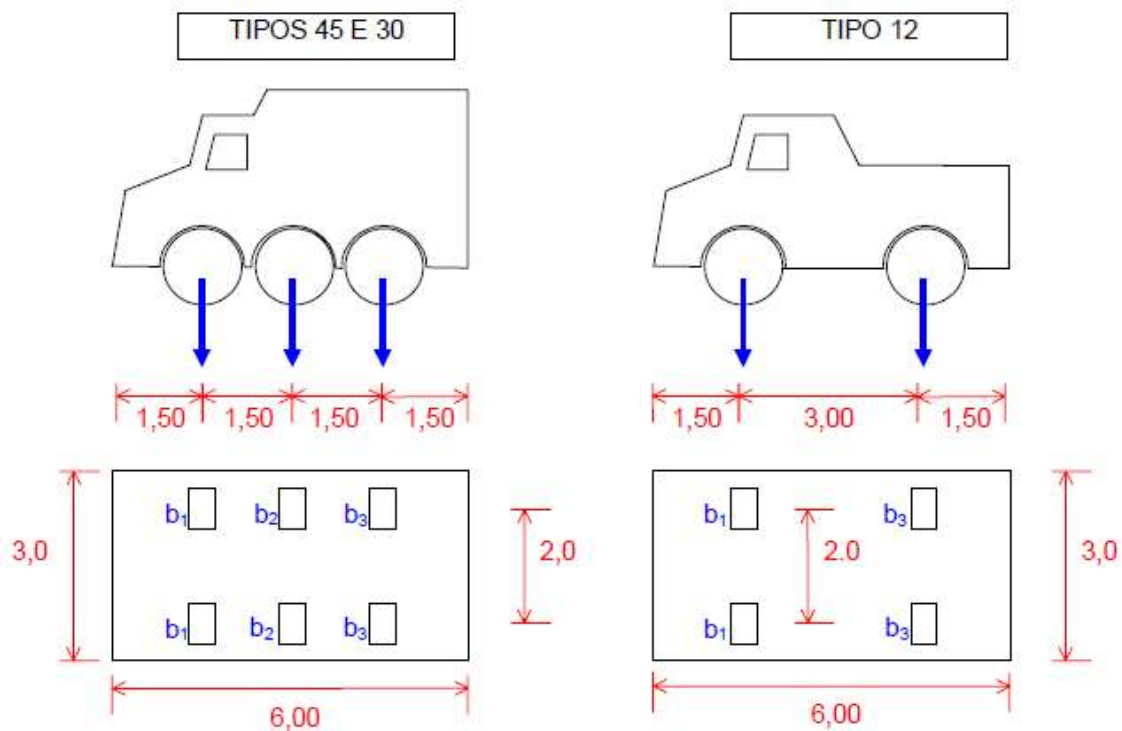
Veículos-Tipo (Fonte: Manual de projeto e construção de pontes de madeira – LaMEM)
